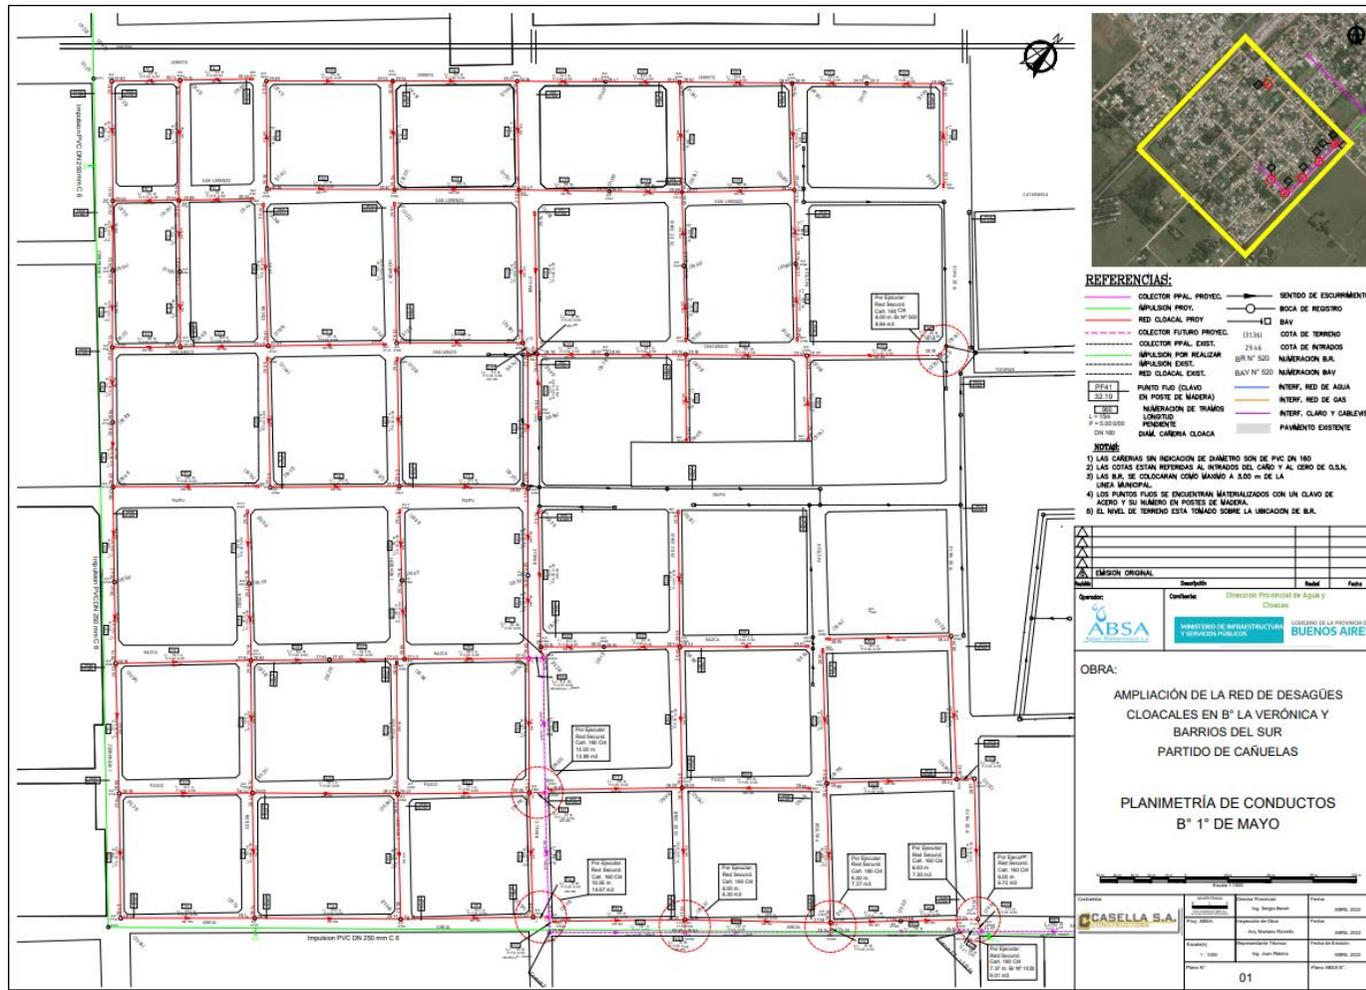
Planimetría de conductos barrio 1° de Mayo.
